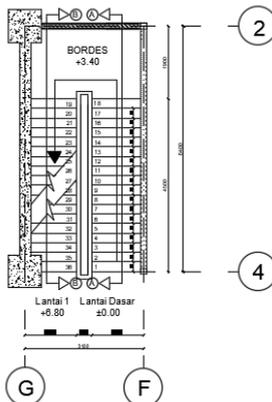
Denah Penempatan Tangga pada Lantai Dasar
